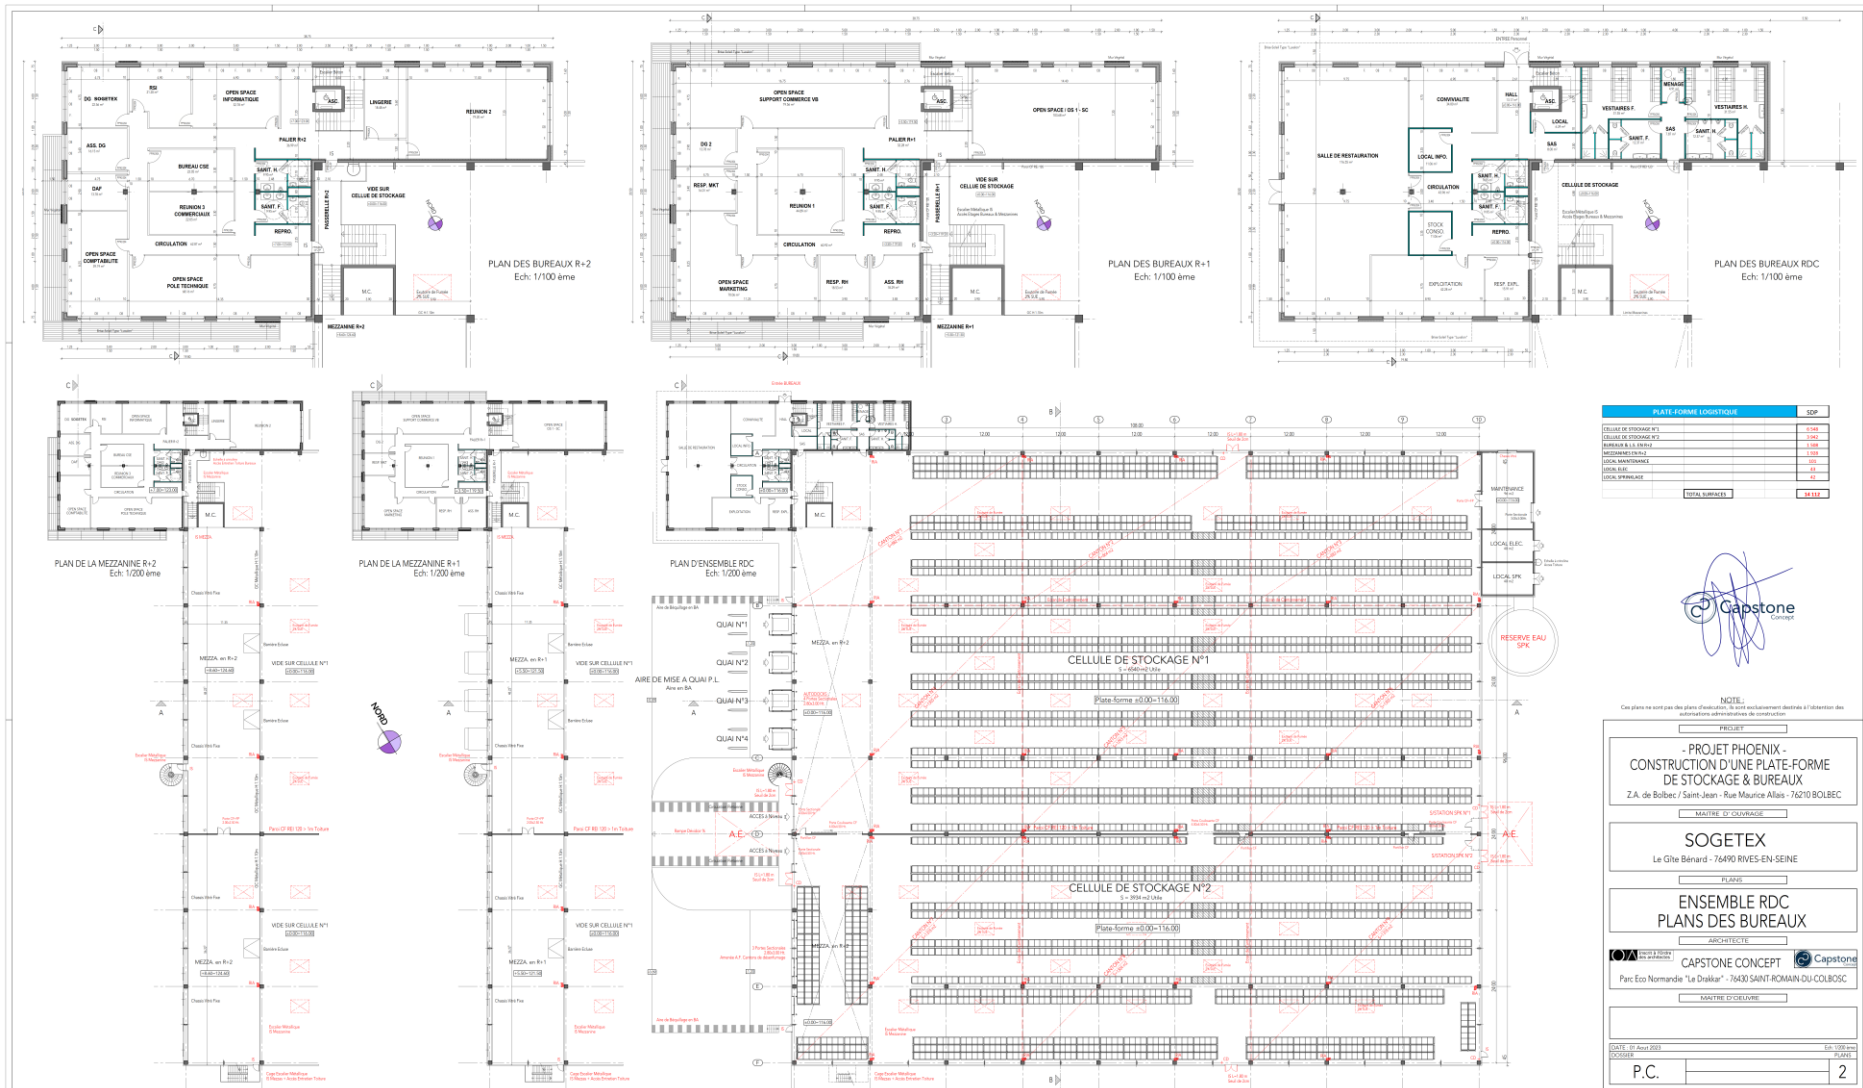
Plan de rez-de-chaussée (source : CAPSTONE CONCEPT)
